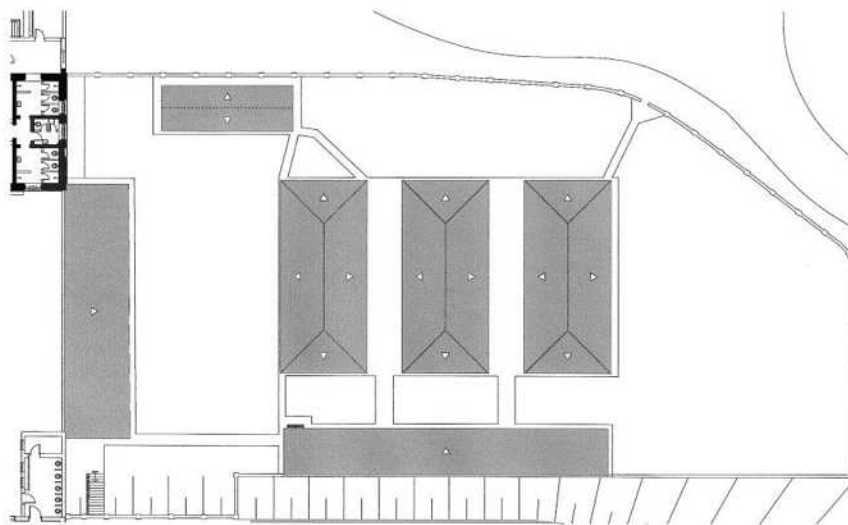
Planta original da construção da área de visitantes do Hospital do Juquery (acervo do SIOC).
